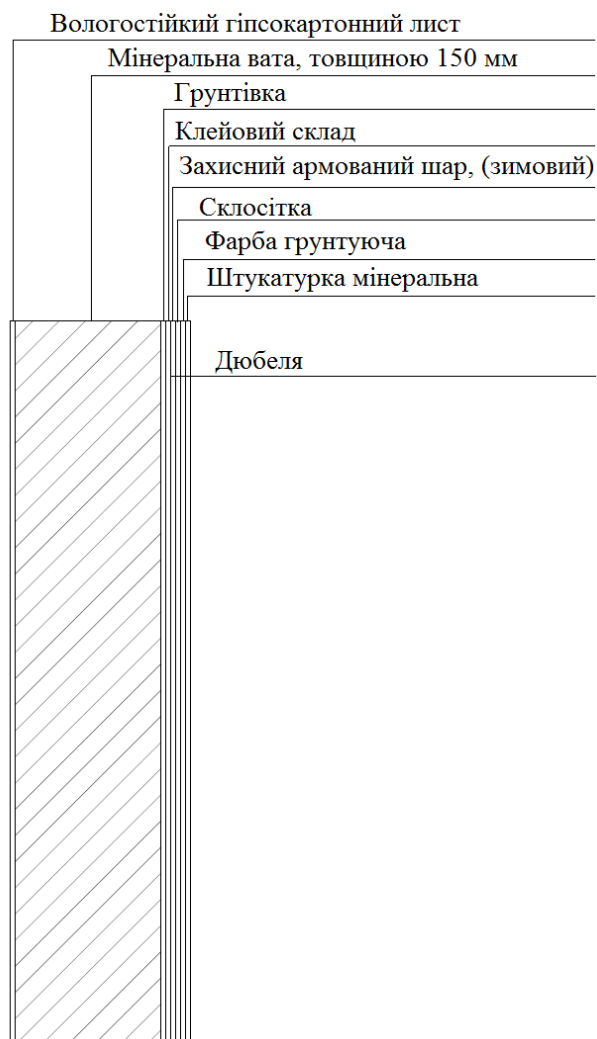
Схема фасадної системи утеплення із експерименту
